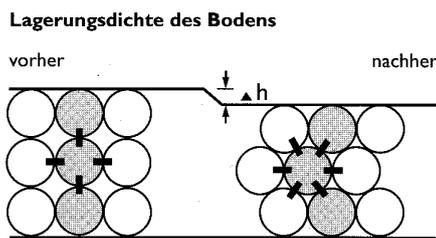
Kornumlagerung bei der Verdichtung [7]
